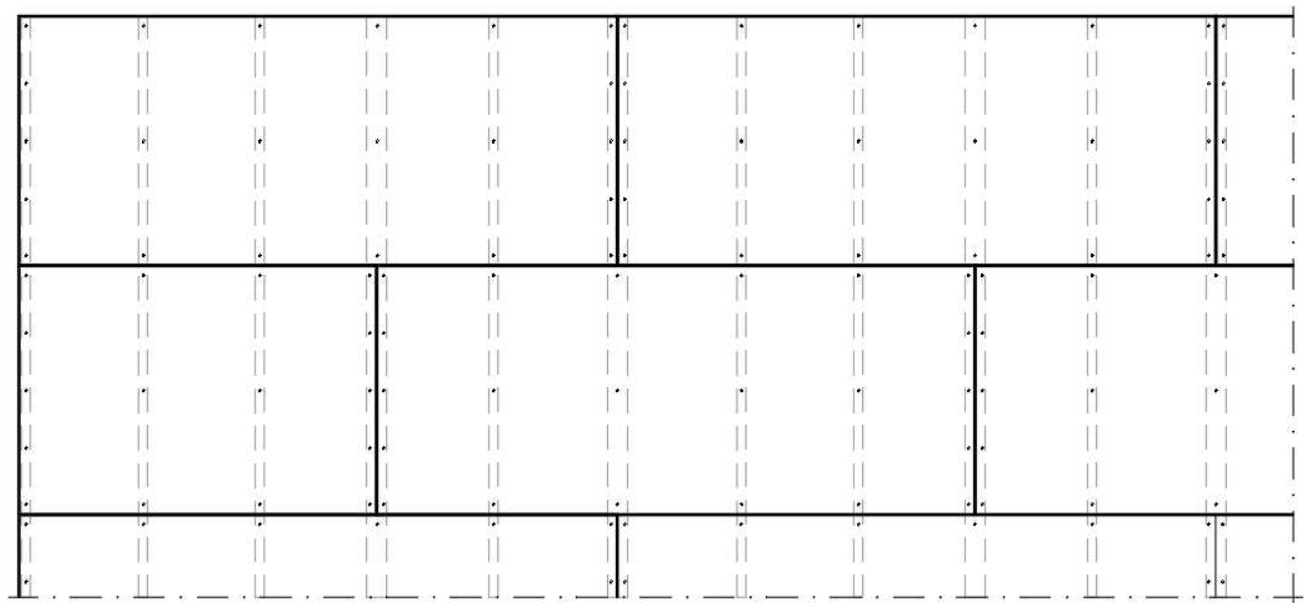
Vista geral de um pavimento apoiado sobre vigas
